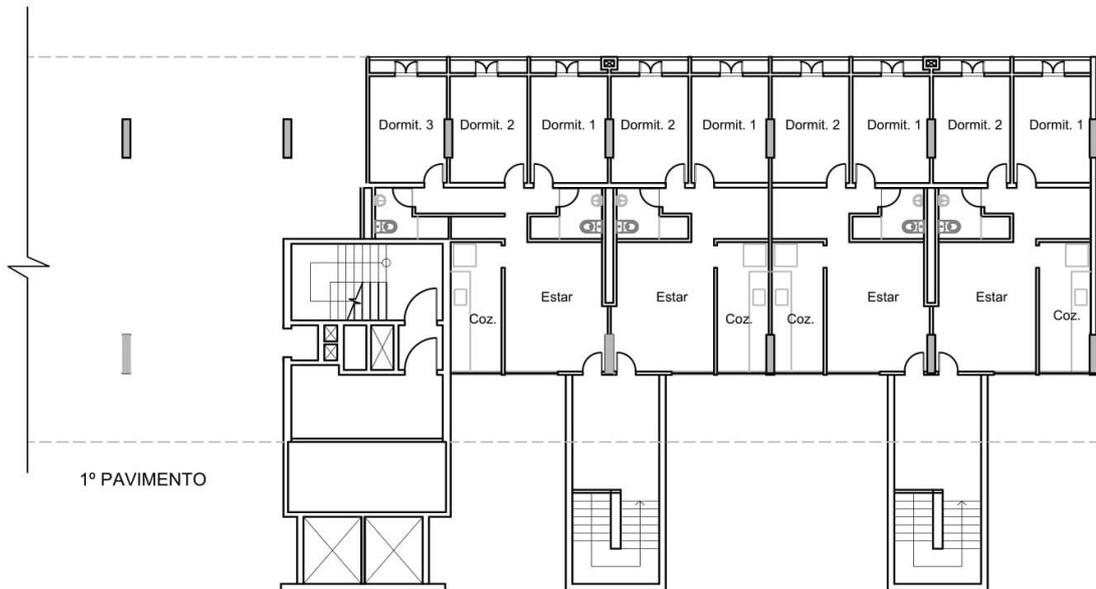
Unidades ampliadas – planta do primeiro pavimento.
